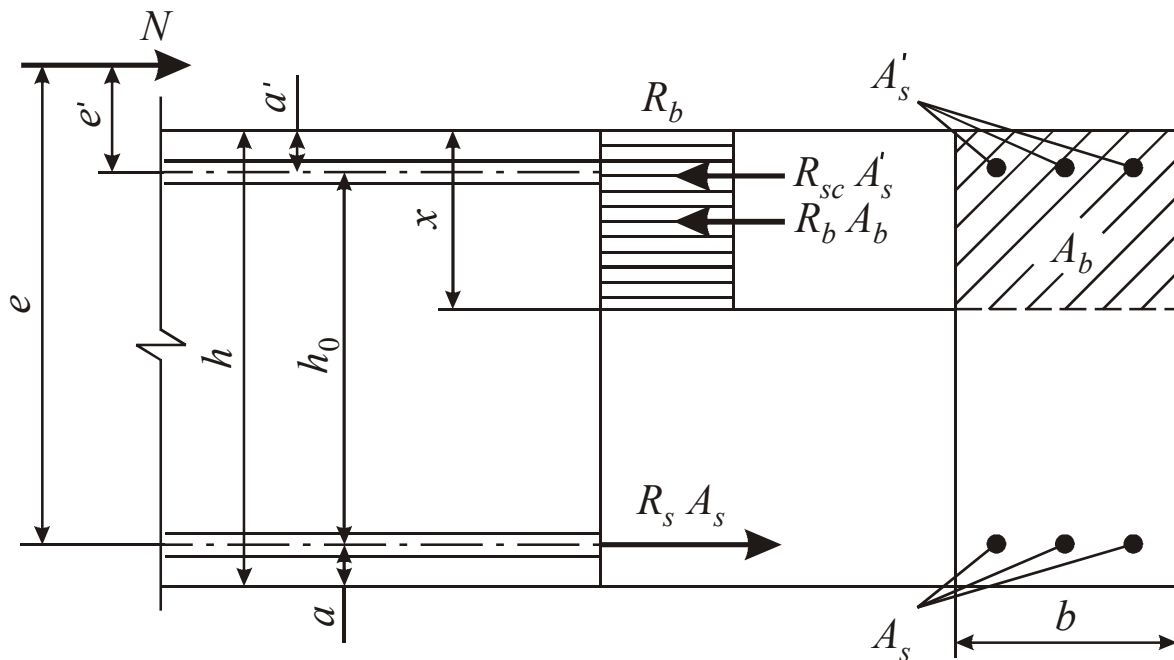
Схема усилий и эпюра напряжений в радиальном сечении железобетонной крепи при расчете ее по прочности
